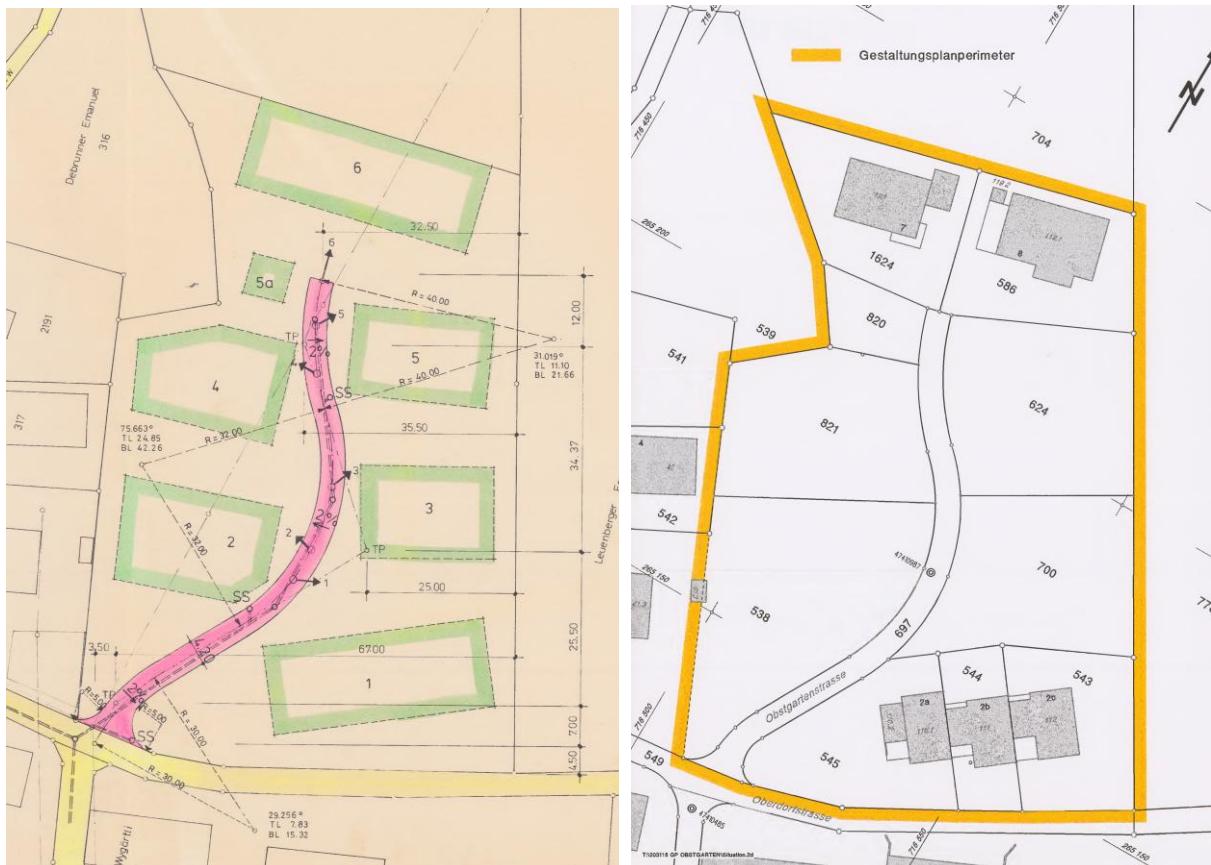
Gestaltungsplan 1988 (aufgehoben) und Gestaltungsplan 2004
